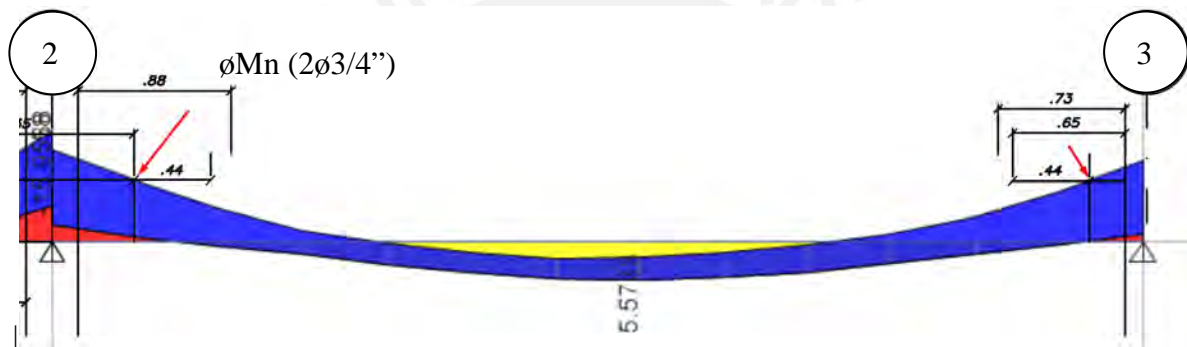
Ubicación del corte de acero de refuerzo tramo 2-3.
